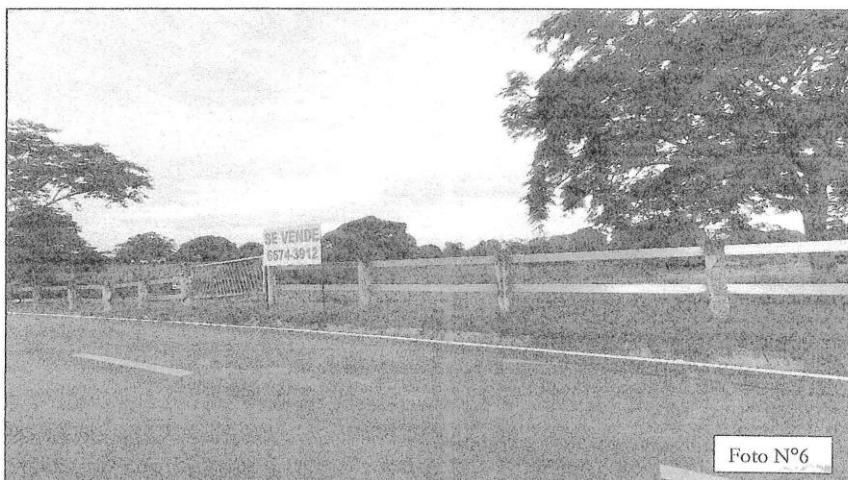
Vista general de la entrada al terreno a desarrollar.
